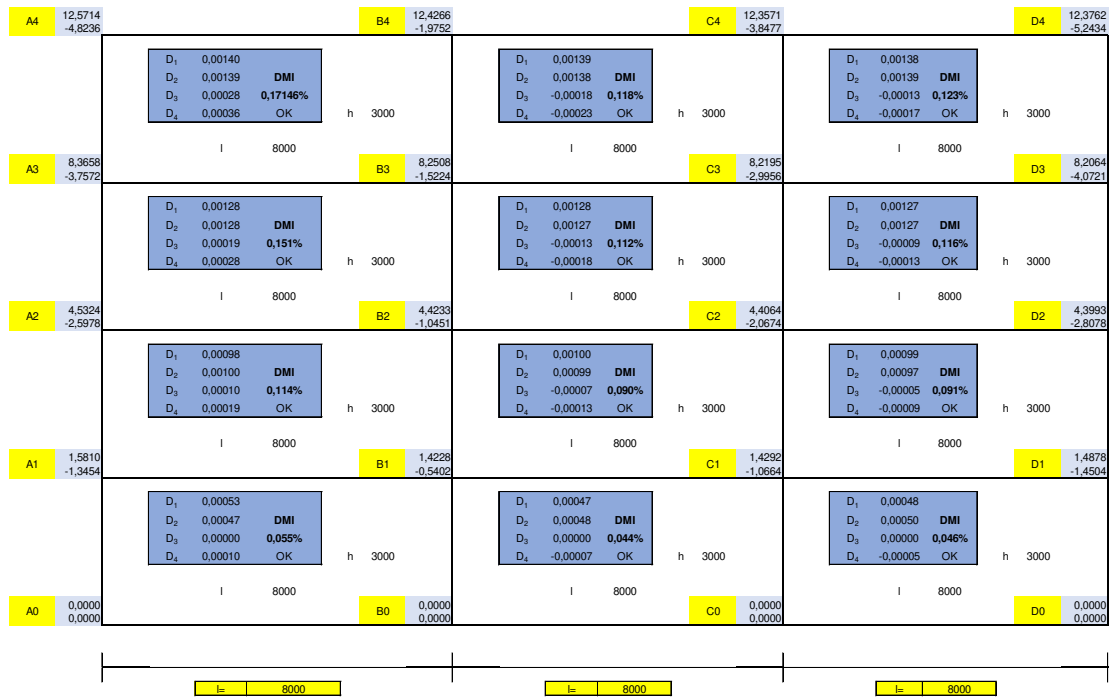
Avaliação das distorções do 13º ao 16º pavimento.
